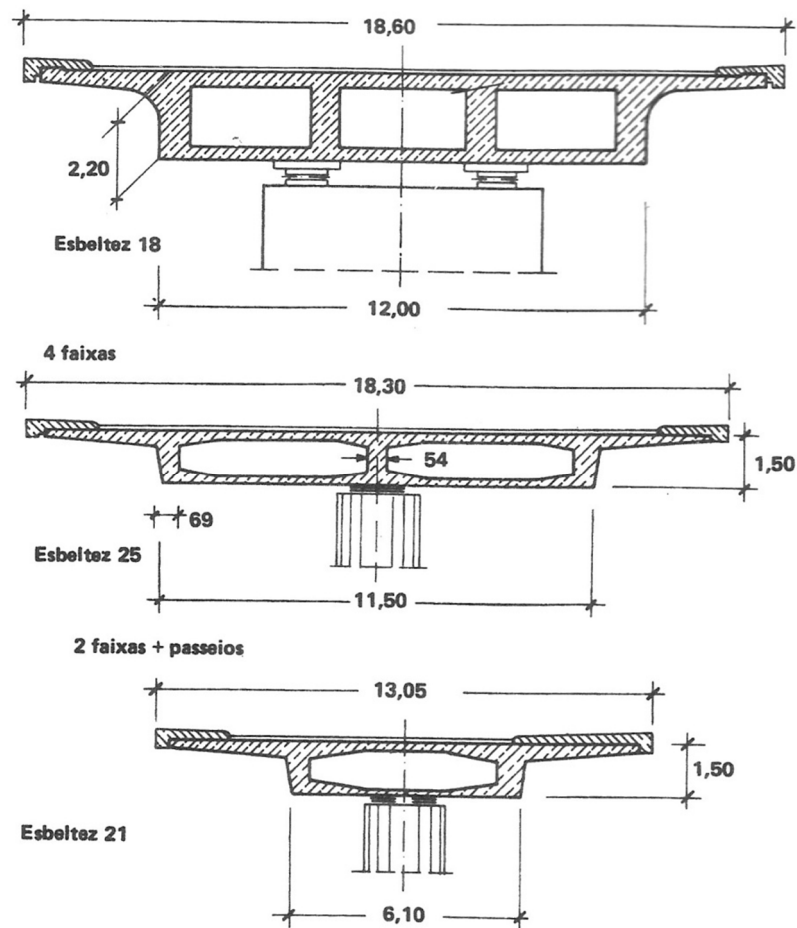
Superestrutura em seção celular (LEONHARDT, 1979)
